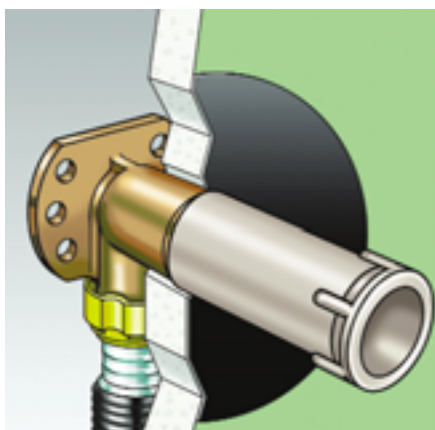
Armaturenanschluss einschließlich Verlängerung und Stopfen
